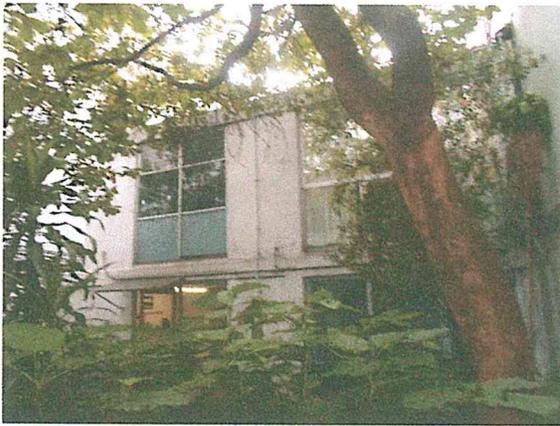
Fachada interior de la primera construcción, en buen estado estructural.
